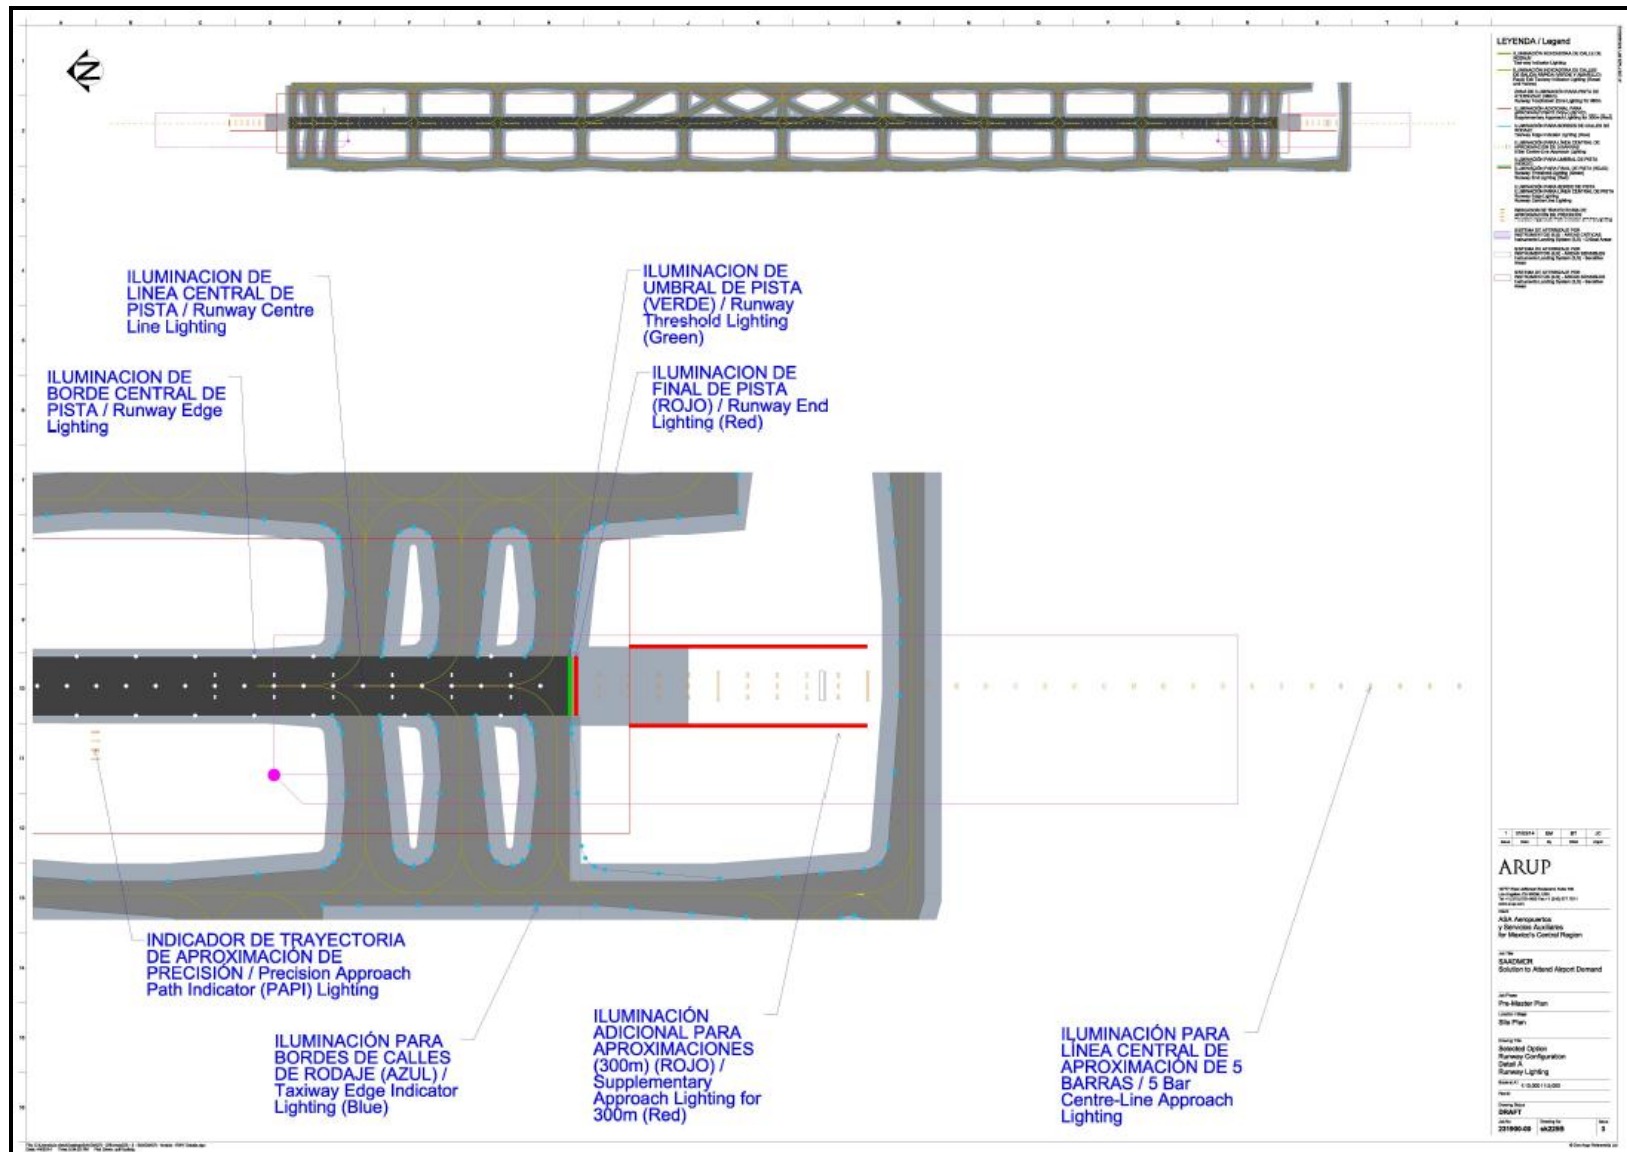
Plano iluminación en pistas y calles de rodaje.
